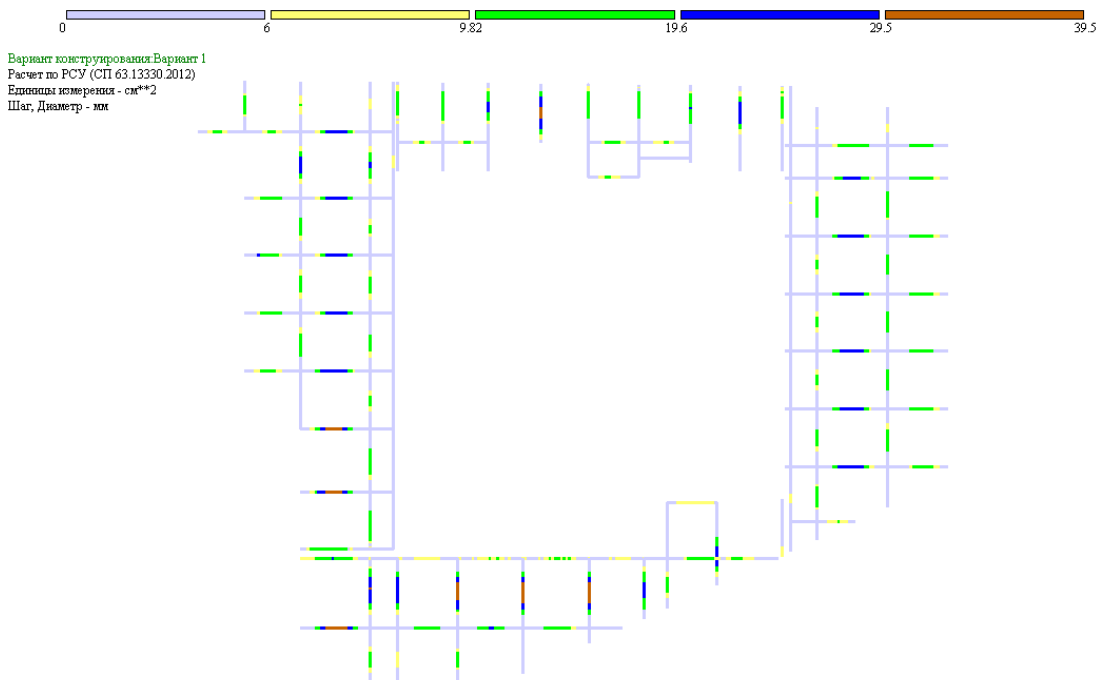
Площадь арматуры ASW1 в балках покрытия
